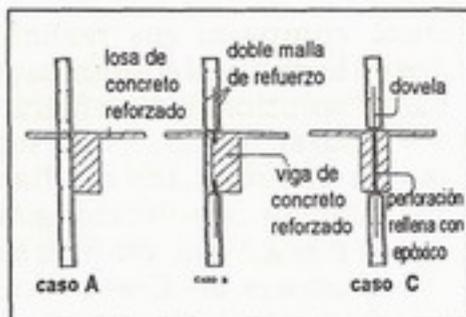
Disposición de muros estructurales con respecto al eje de la viga y columna. Detalles constructivos para dar continuidad al refuerzo vertical.
